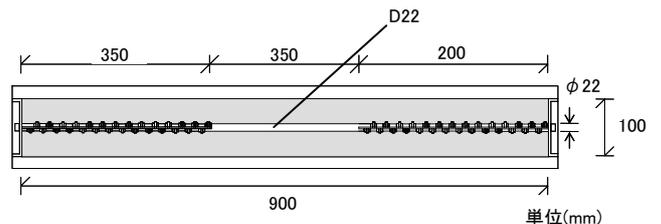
乾燥収縮ひび割れ試験の供試体
